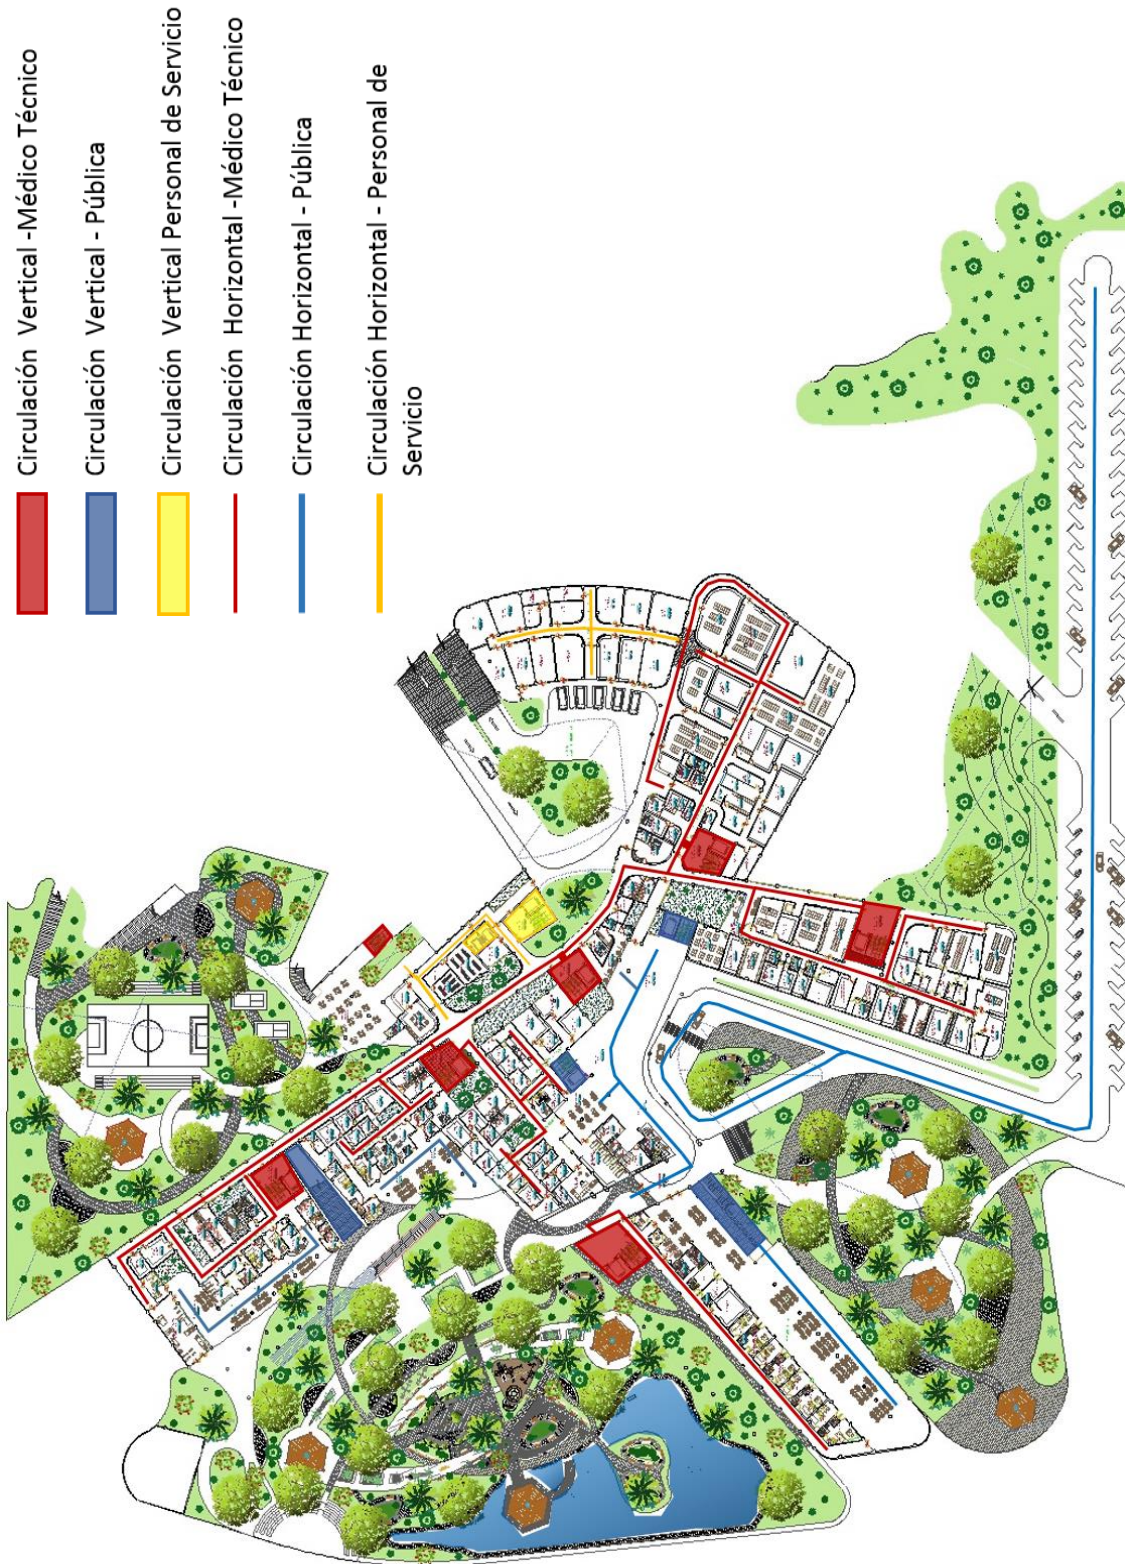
Circulación de Planta Baja de la Propuesta Arquitectónica.
